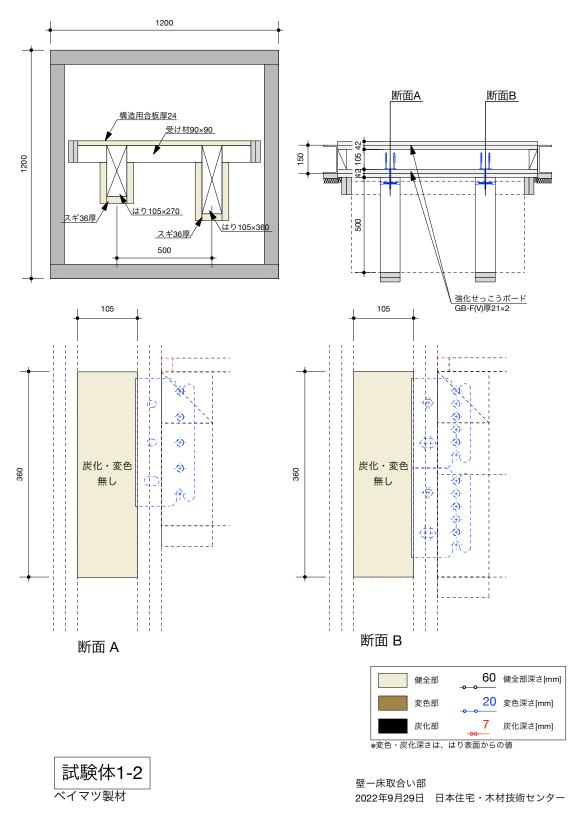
試験体 1-2 炭化図 (単位: mm)
